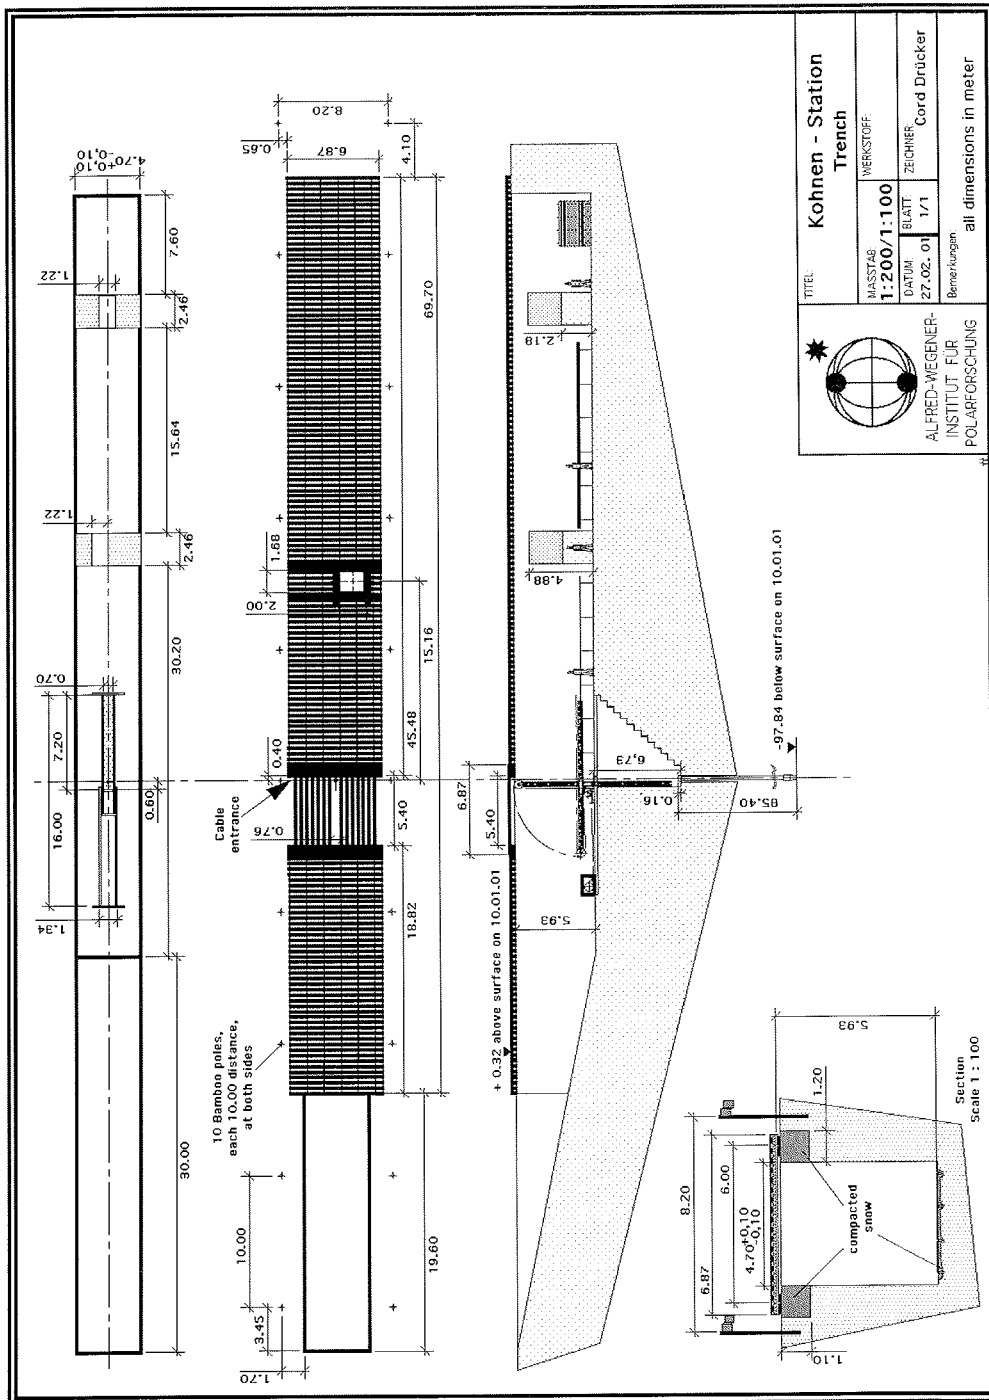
Grundriss, Aufsicht und Längsschnitt des Drill- und Science-Trenches des EPICA-Bohrcamps (Kohnen-Station) in Dronning Maud Land
